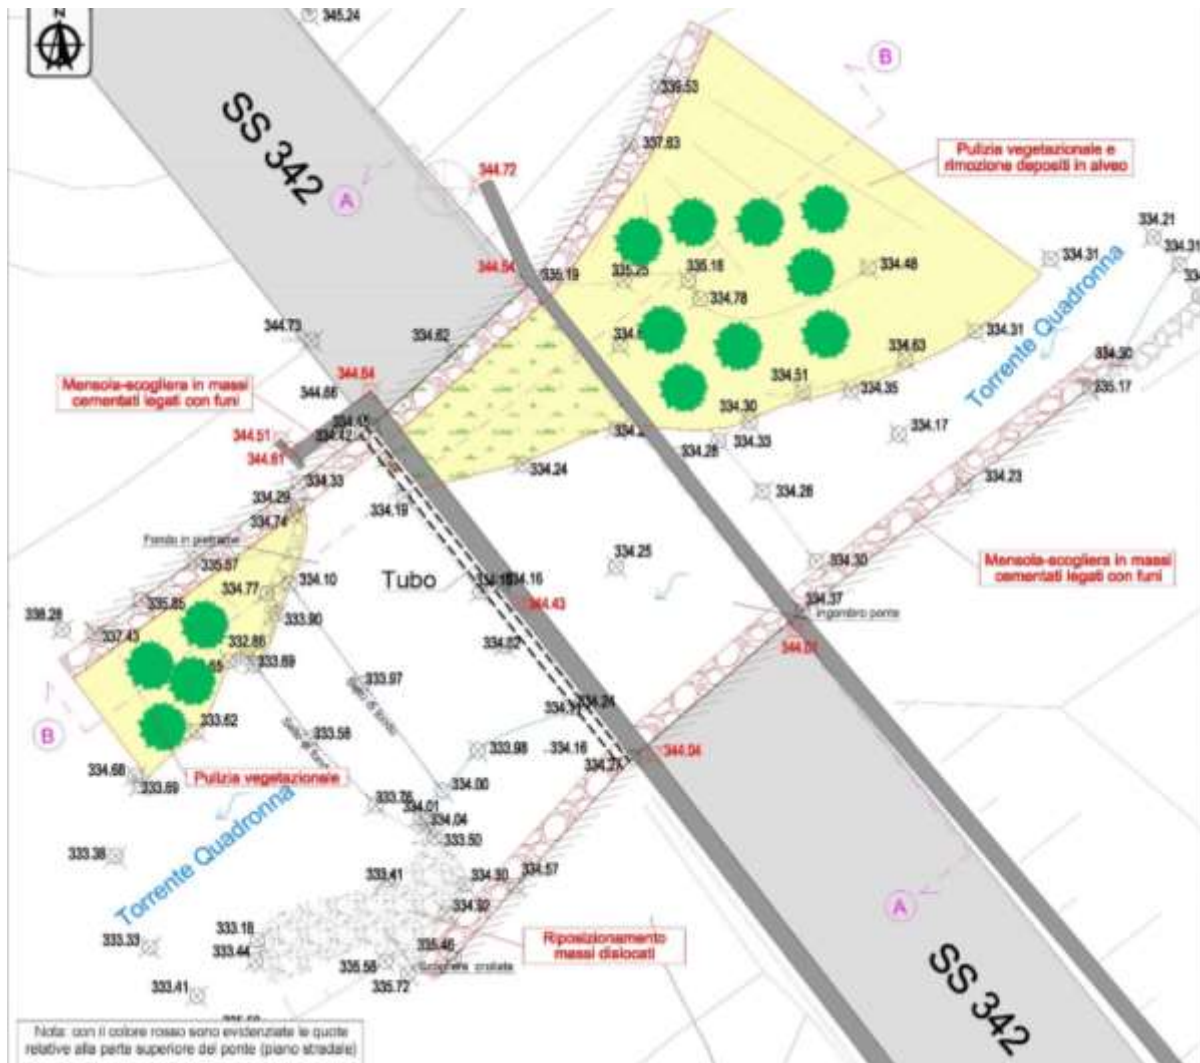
Planimetria di progetto (estratto Tavola 1.3)
